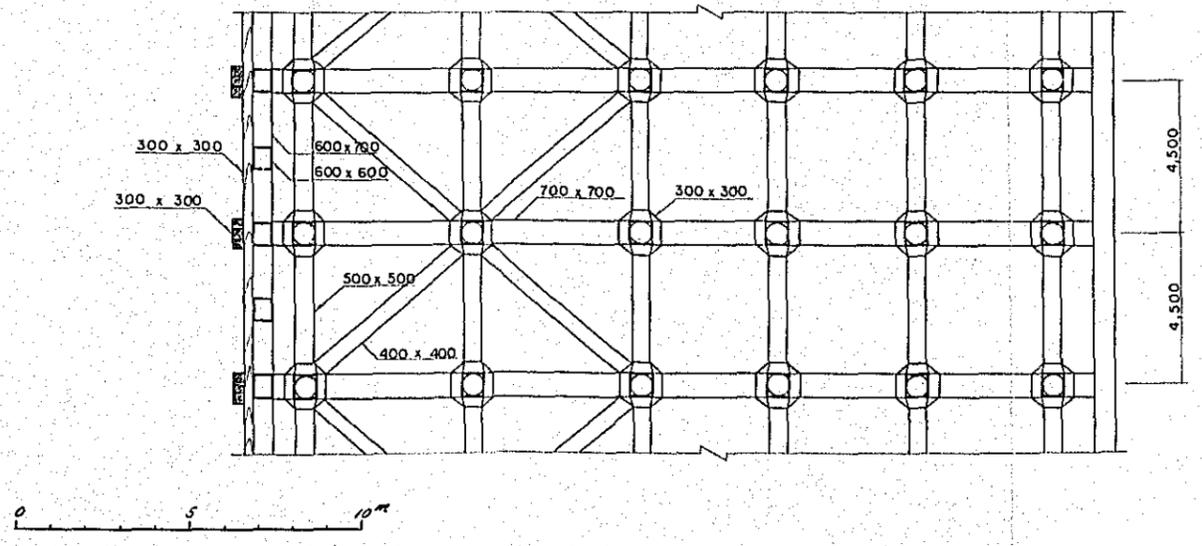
PLAN DE STRUCTURE DE QUAI D'AMARRAGE DU PORT DE PHNOM-PENH
